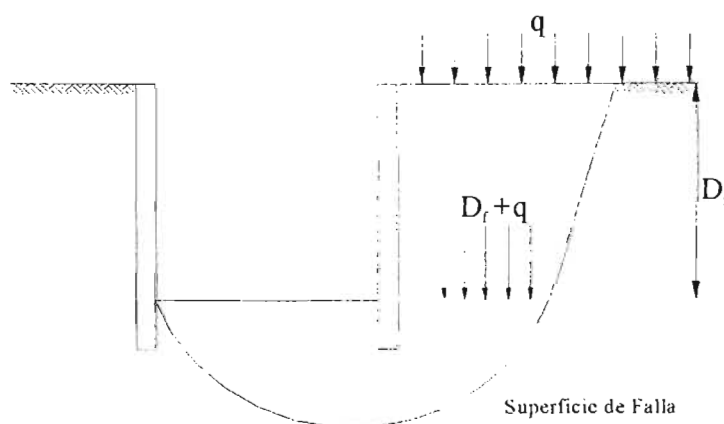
Mecanismo de falla de fondo en excavación en arcilla.
